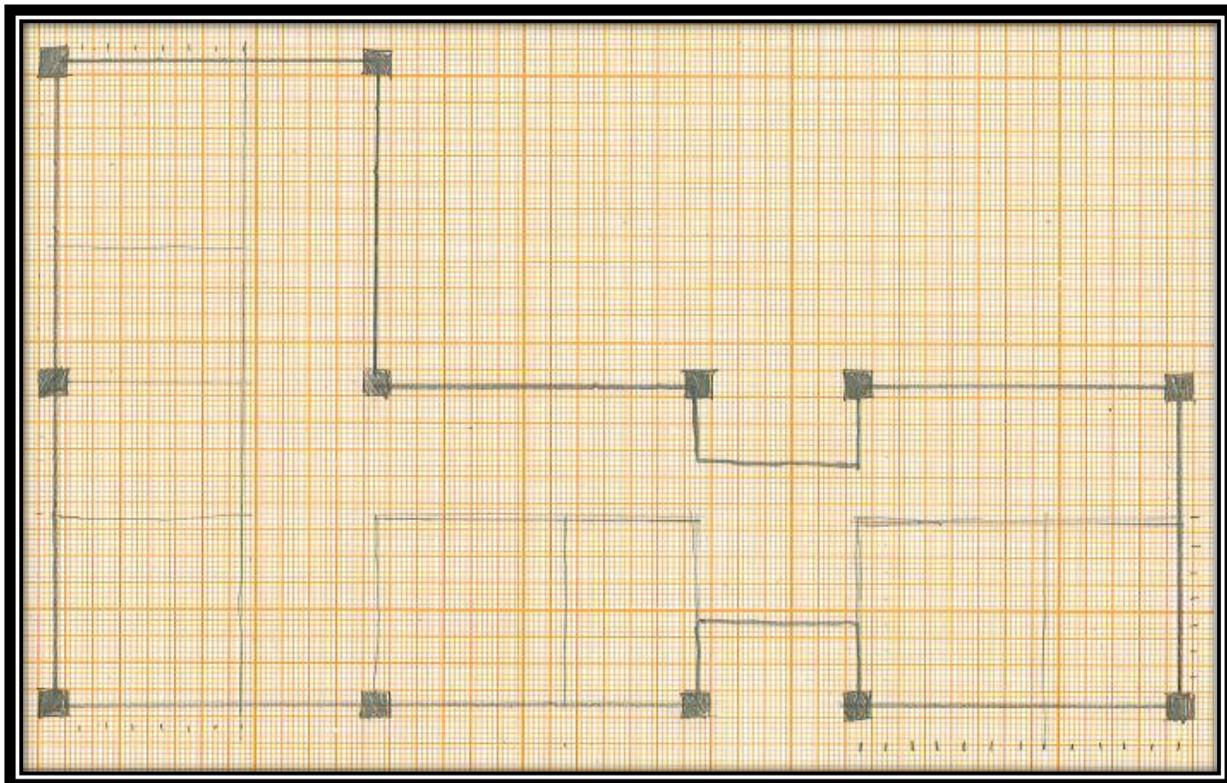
Primera distribución de departamentos en la planta tipo.
